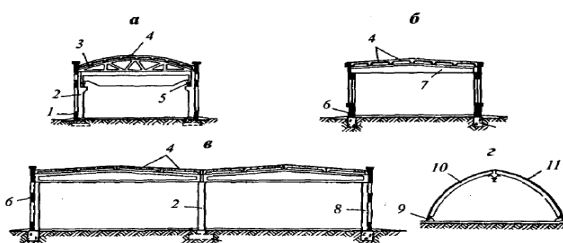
Конструктивные типы одноэтажных промышленных зданий: а—каркасный; б—бескаркасный; в—с неполным каркасом; г—шатровый; 1—наружная стена; 2—колонна; 3—ферма; 4—плиты покрытия; 5—подкрановая балка; 6—несущая стена; 7—балка покрытия; 8—пилястра; 9—фундамент; 10—арка; 11—покрытие по верху арки.
